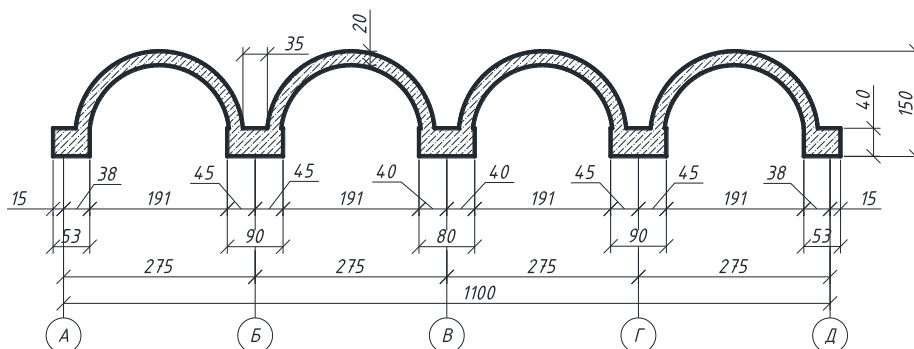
Схема поперечного сечения многоволновой плиты перекрытия. Вариант со сферическим очертанием элементов — полутруб (разработано автором)
